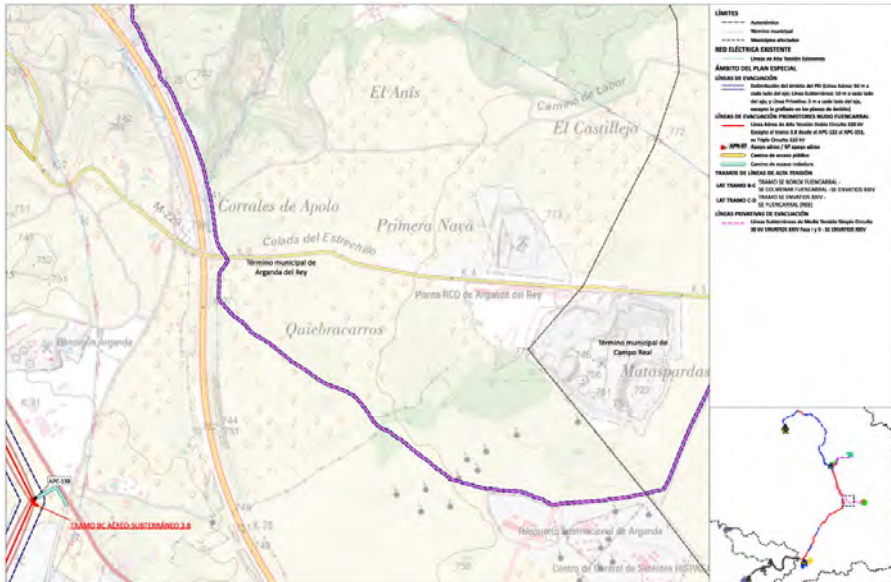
Plano de Ordenación O2.4.3. Planta por tramos. Instalaciones Envaios XXIV
